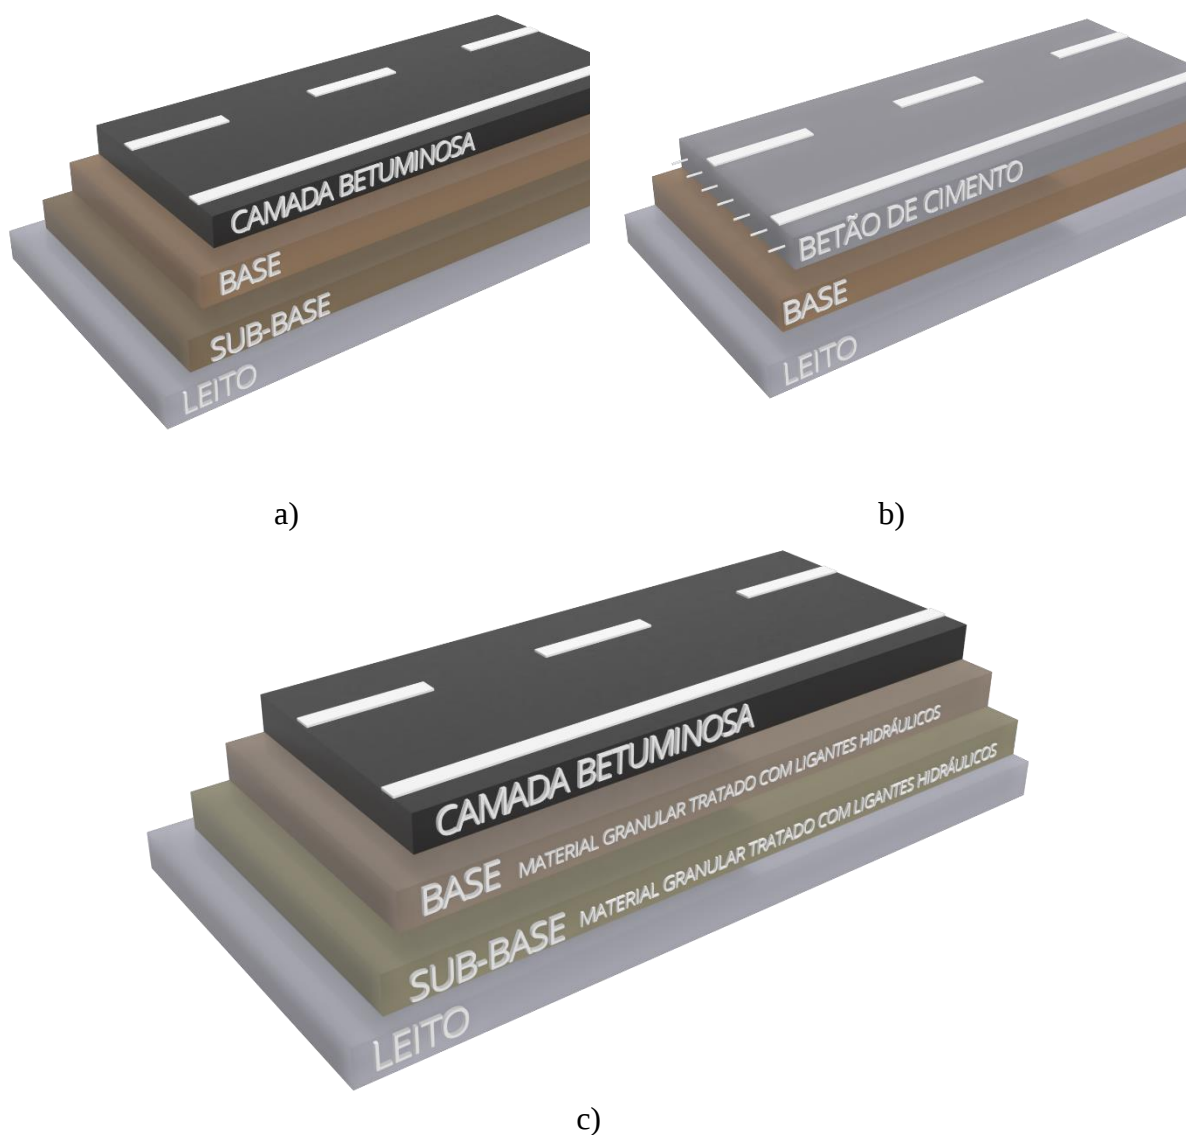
Representação esquemática: a) pavimento flexível b) pavimento rígido c) pavimento semirrígido
